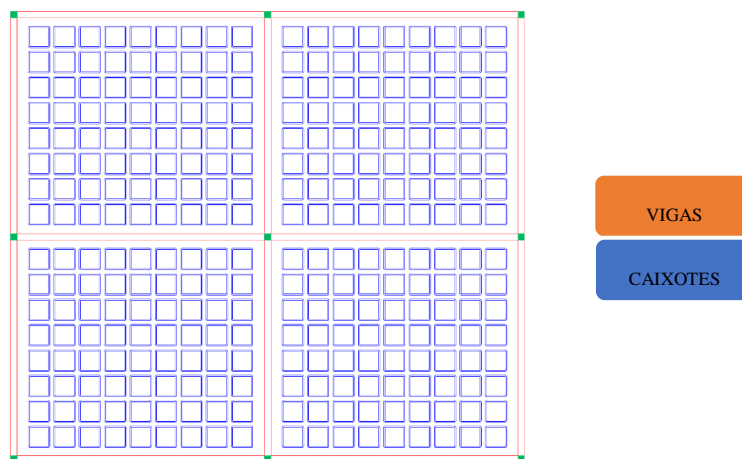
Tipologia de pavimento estudado. (Fonte: autor)
